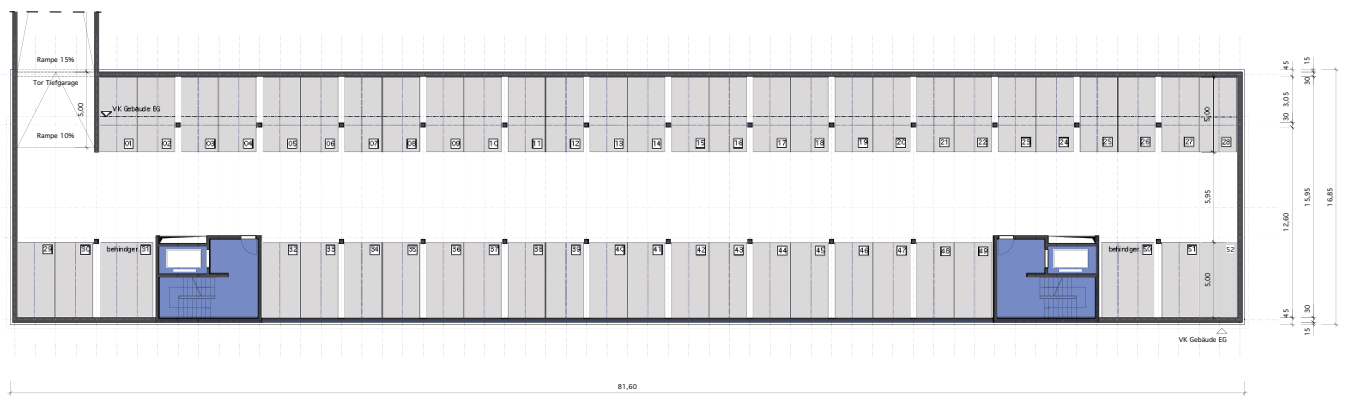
Grundrisse Referenzgebäude „mittlere Variabilität“ für eine Büronutzung
